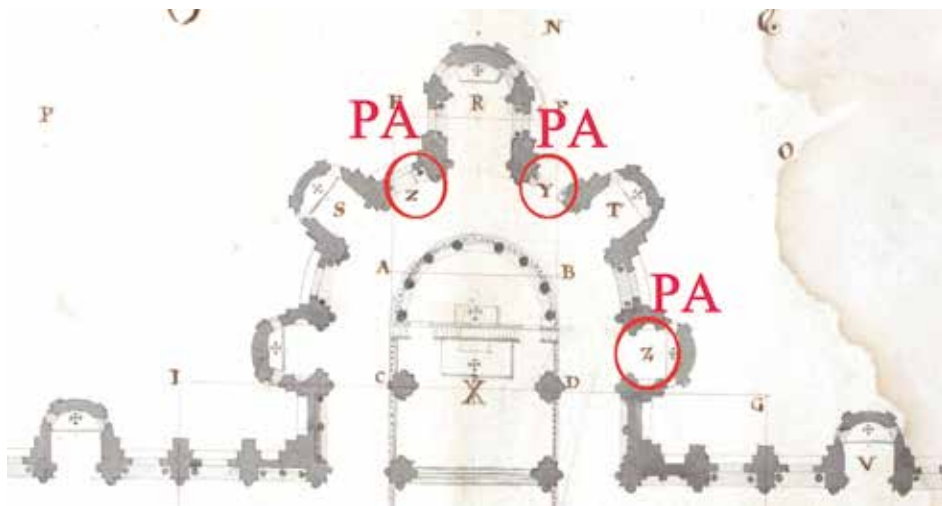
Detalle del Plano I (M. Ferro Caaveiro).
